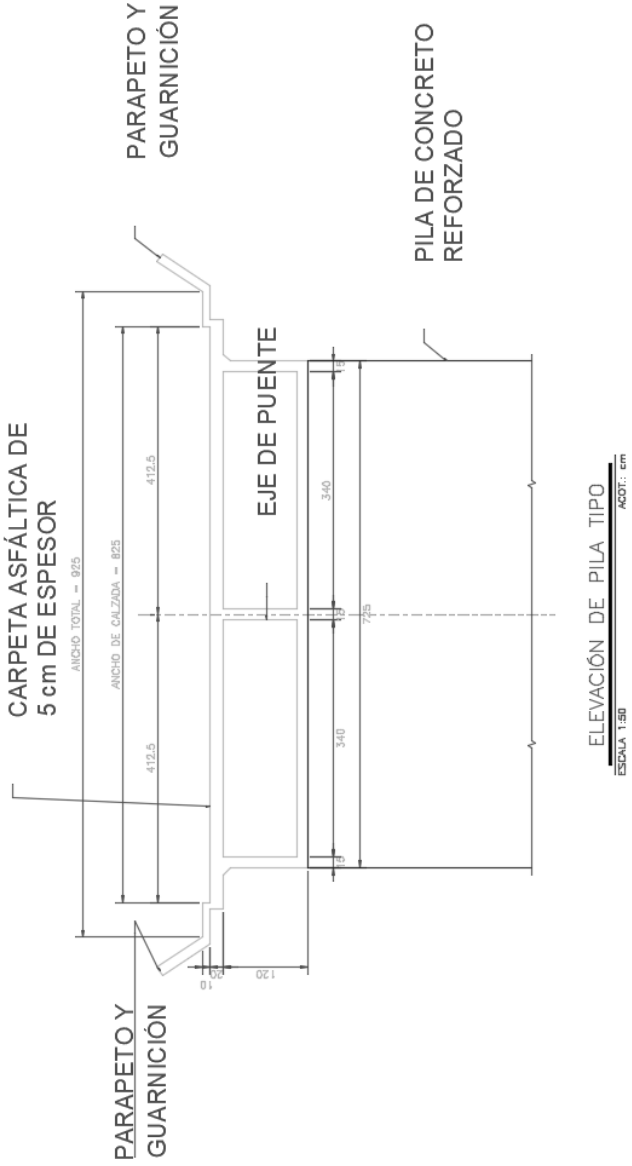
Vista en corte de la superestructura (vigas cajón de sección variable)
